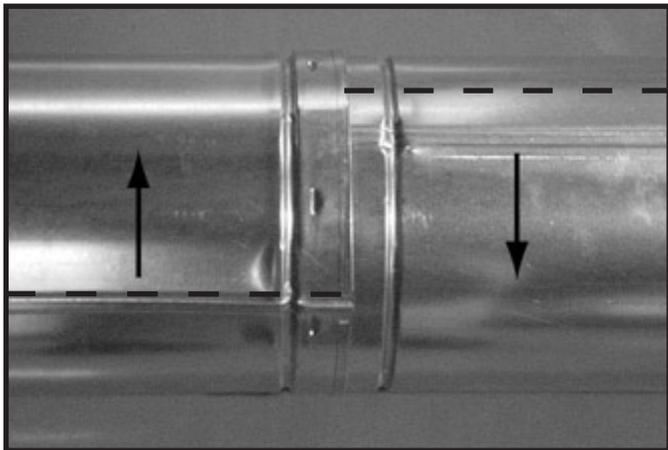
Faire tourner les joints d'assemblage pour le démontage
